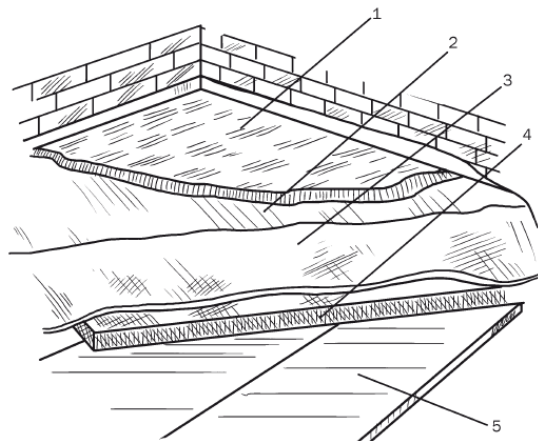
Устройство «плавающего» основания: 1 – стяжка; 2 – пленка; 3 – первый изоляционный слой; 4 – второй изоляционный слой; 5 – гидроизоляционный слой
